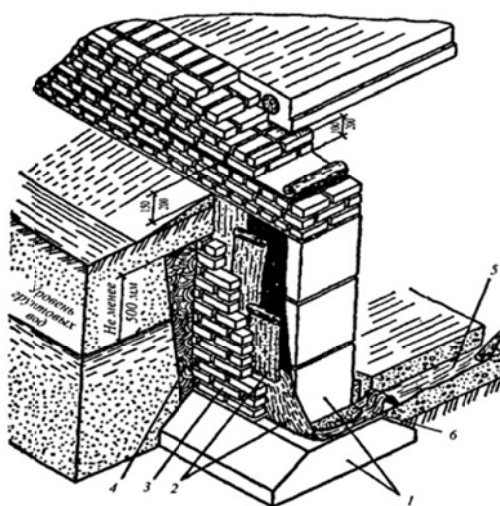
Устройство оклеечной гидроизоляции в здании с подвалом:
